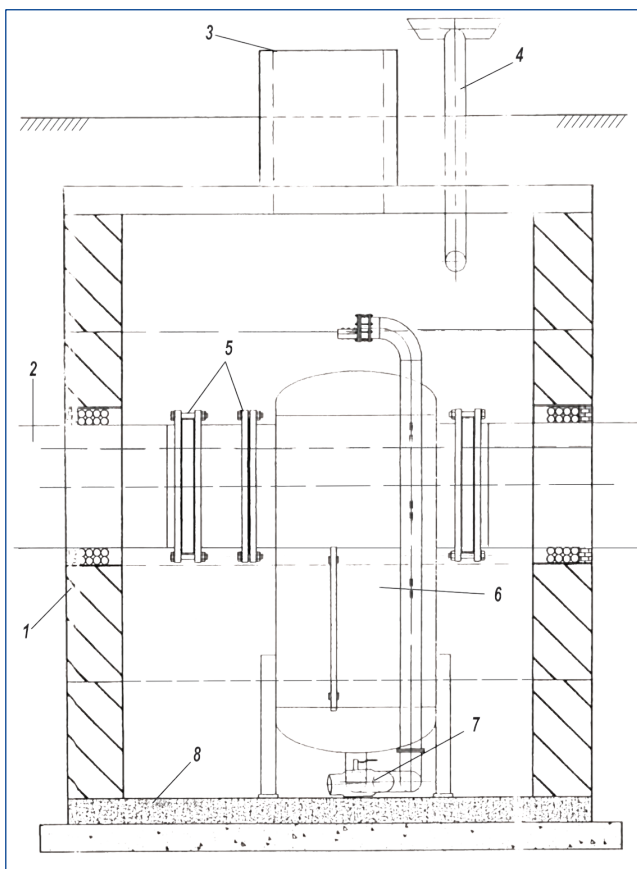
Конструкция колодца для сбора конденсата: 1 – стены колодца из сборного железобетона; 2 – полиэтиленовые трубы дегазации Ø 630 мм; 3 – люк для спуска обслуживающего персонала; 4 – труба-дефлектор для отвода газа; 5 – стыковые соединения; 6 – емкость для сбора конденсата; 7 – сливной вентиль; 8 – дренажный слой.
